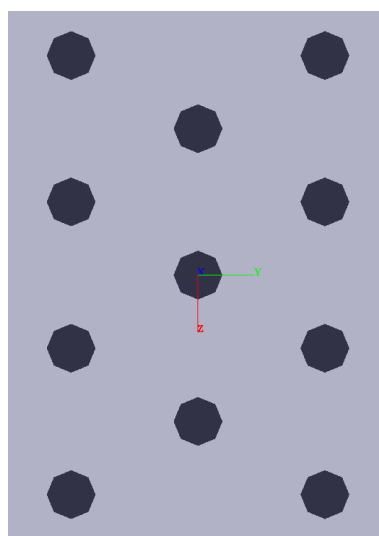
Vista planimetrica del modello GROUPv2016.
